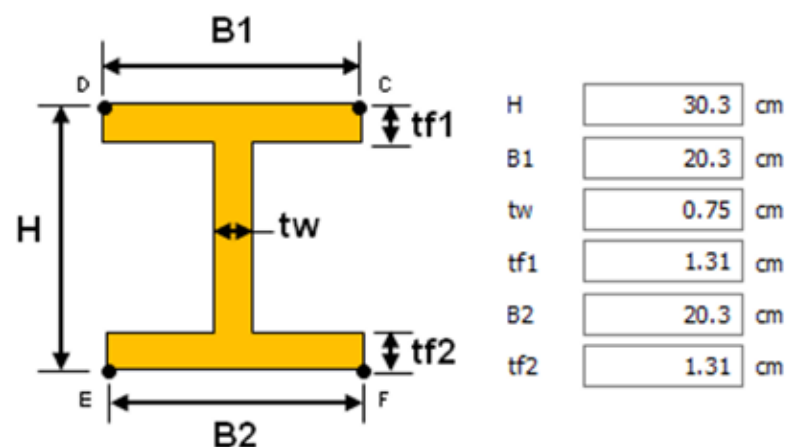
Geometría del pilote empleado en las pruebas de carga.
